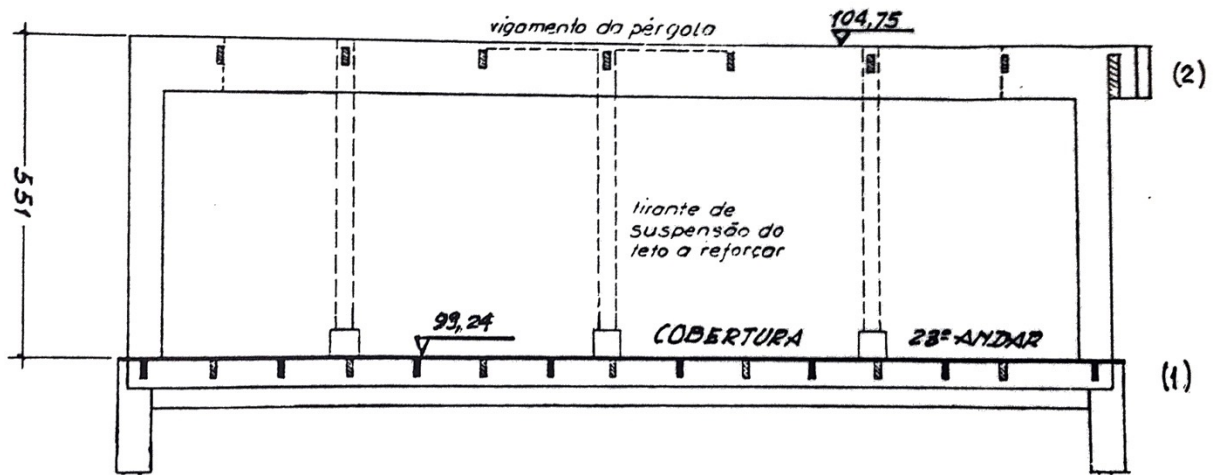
Solução adotada para transformar a laje de cobertura em laje de piso: o pórtico da pérgola suspende a laje por meio de 3 tirantes. FONTE: CONCRETO, 1945.
